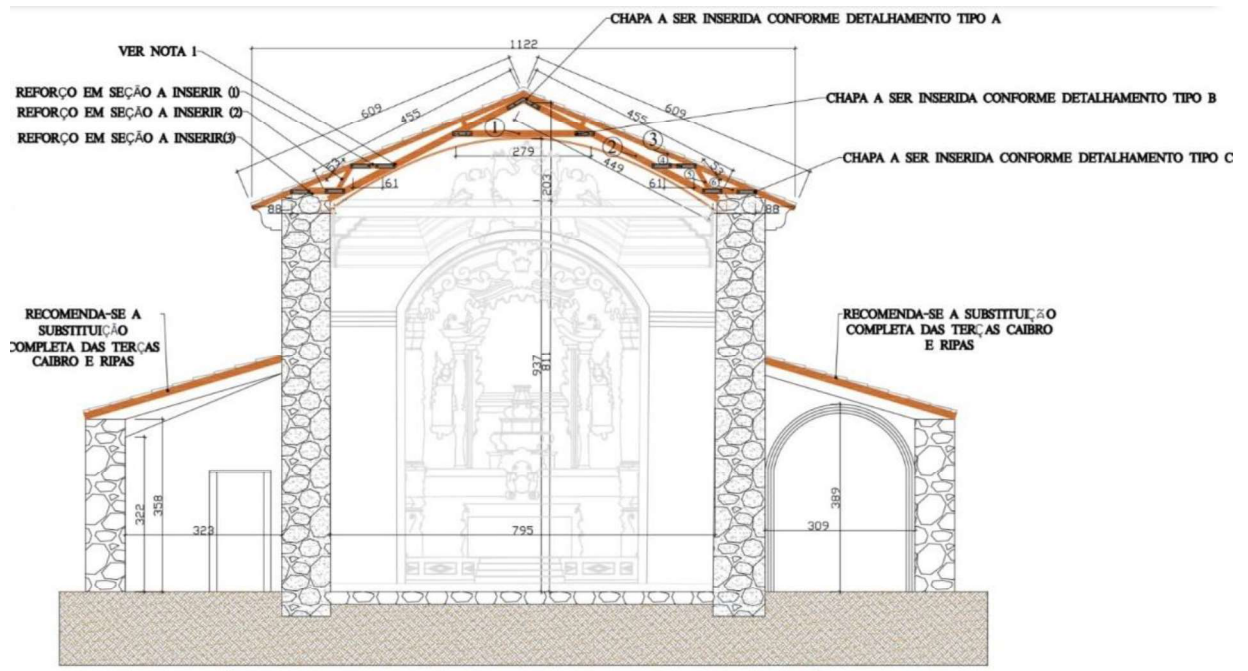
Corte em projeto da nave igreja, destacando a tesoura do telhado.
